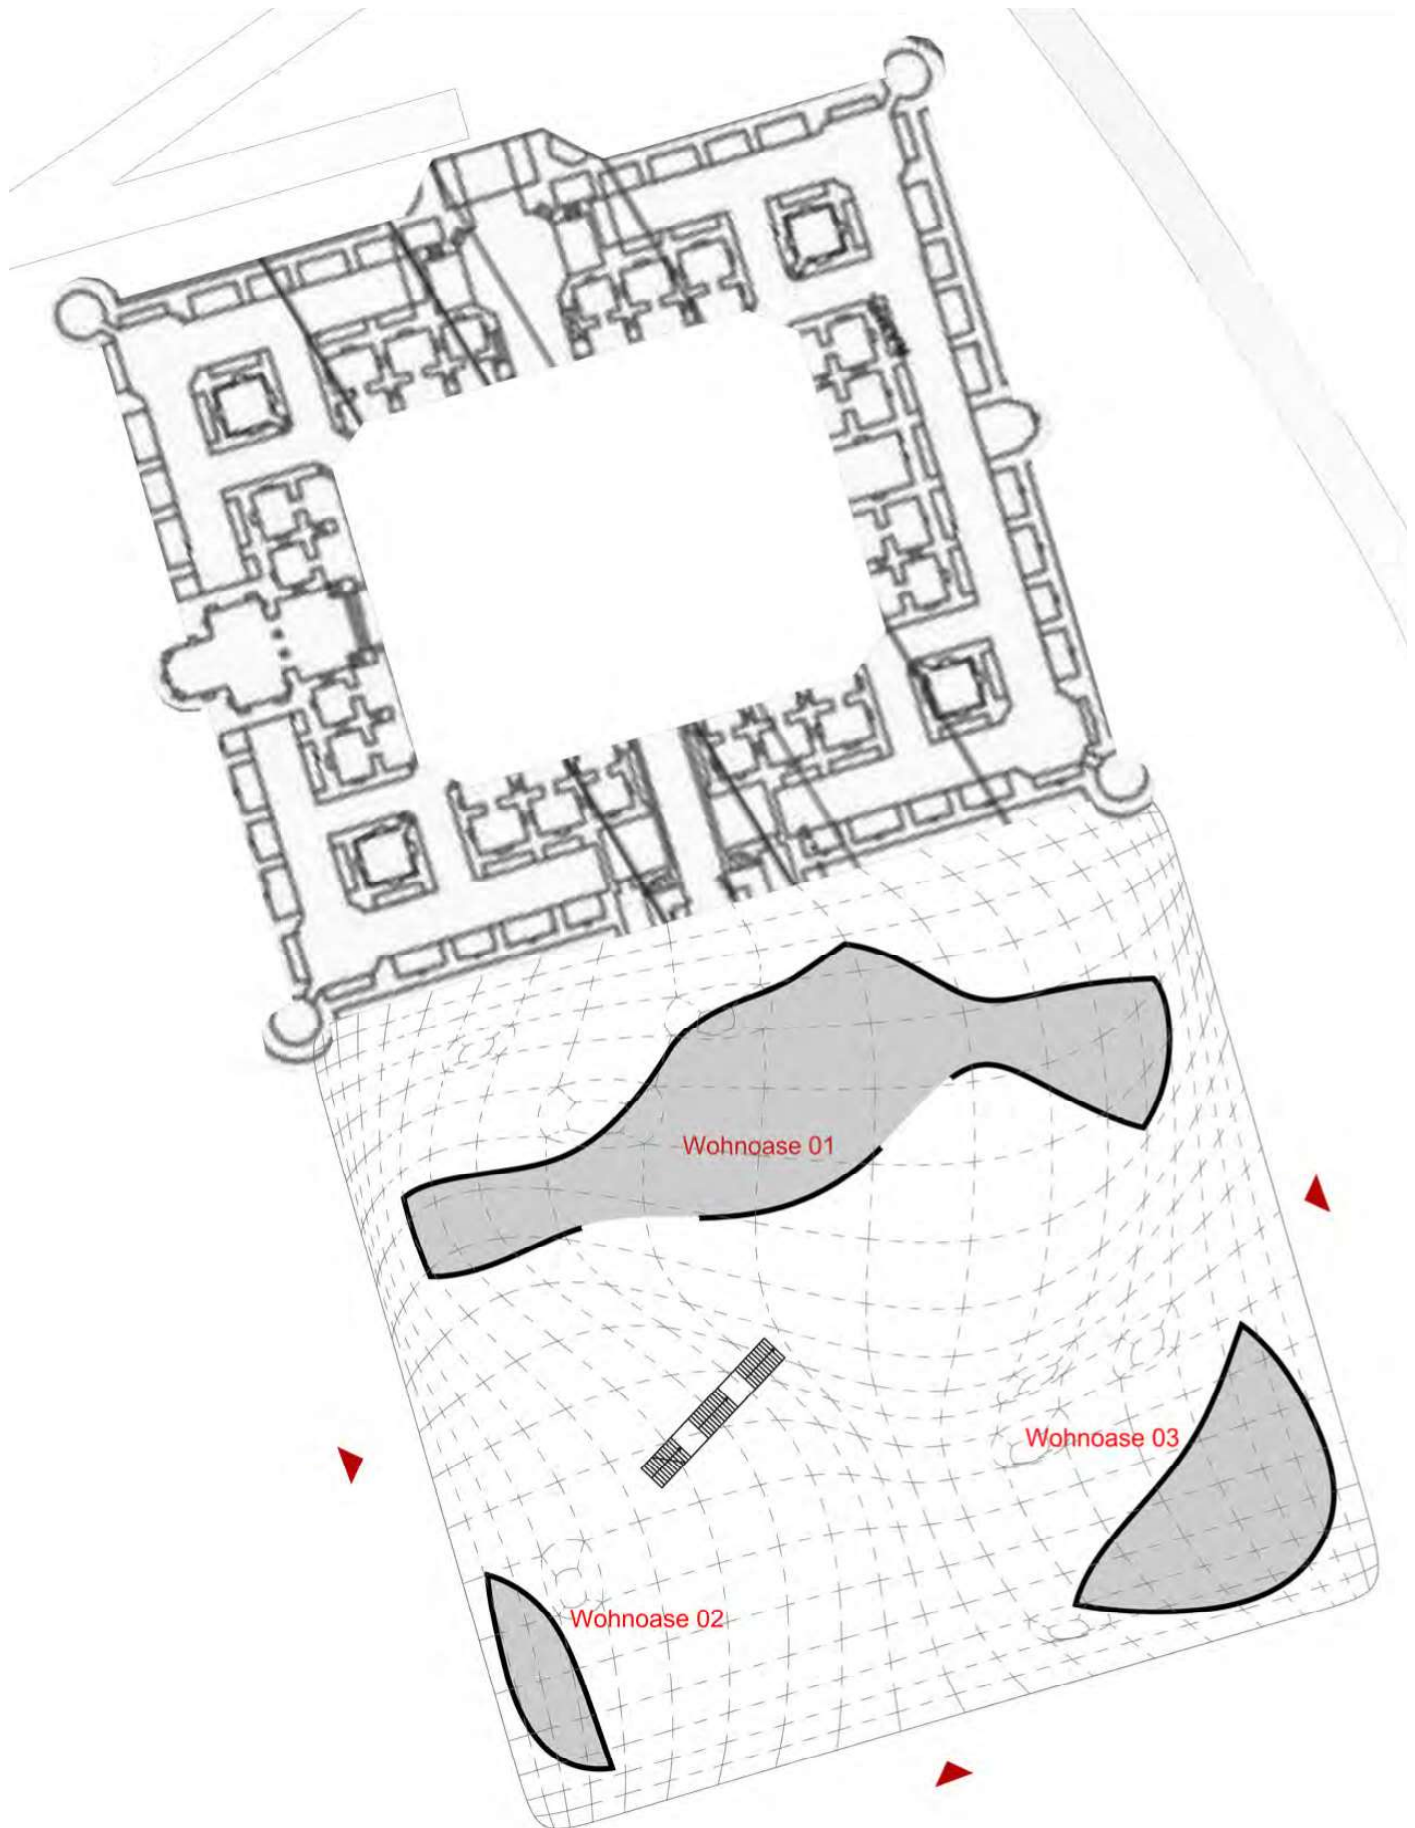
Formfindung, Erdgeschoss, Grundrisskonzept
